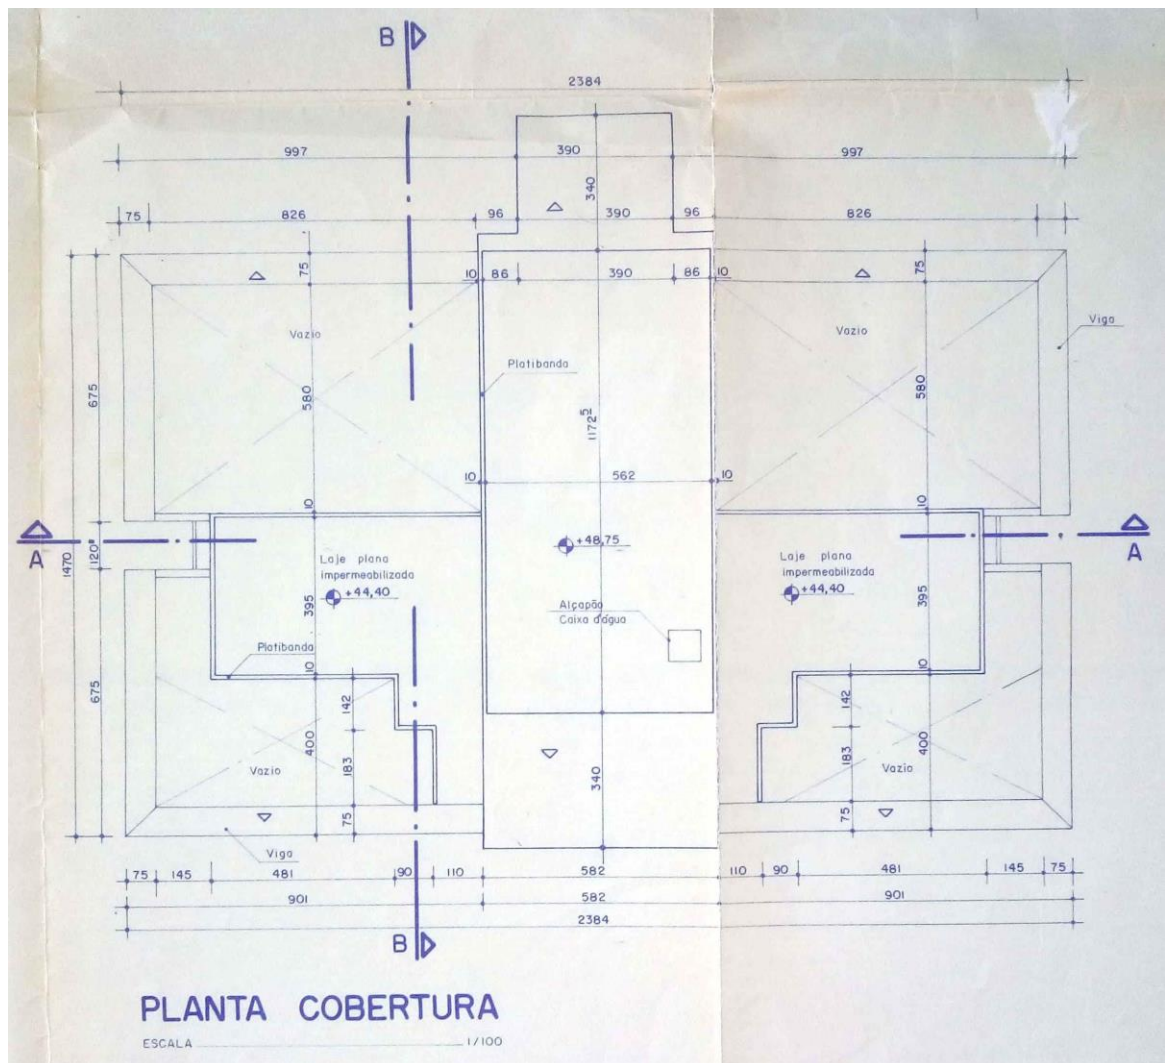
Planta do pavimento de cobertura (forro da cobertura).
